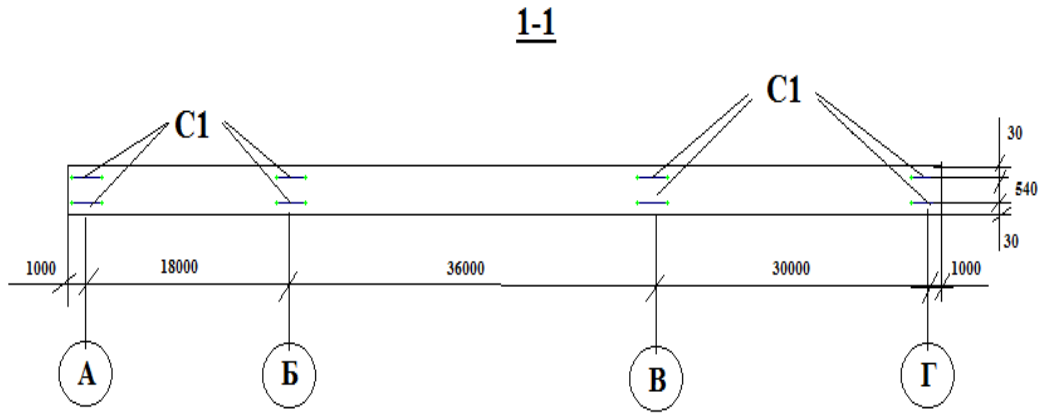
Фундаментна плита. Розріз 1-1
